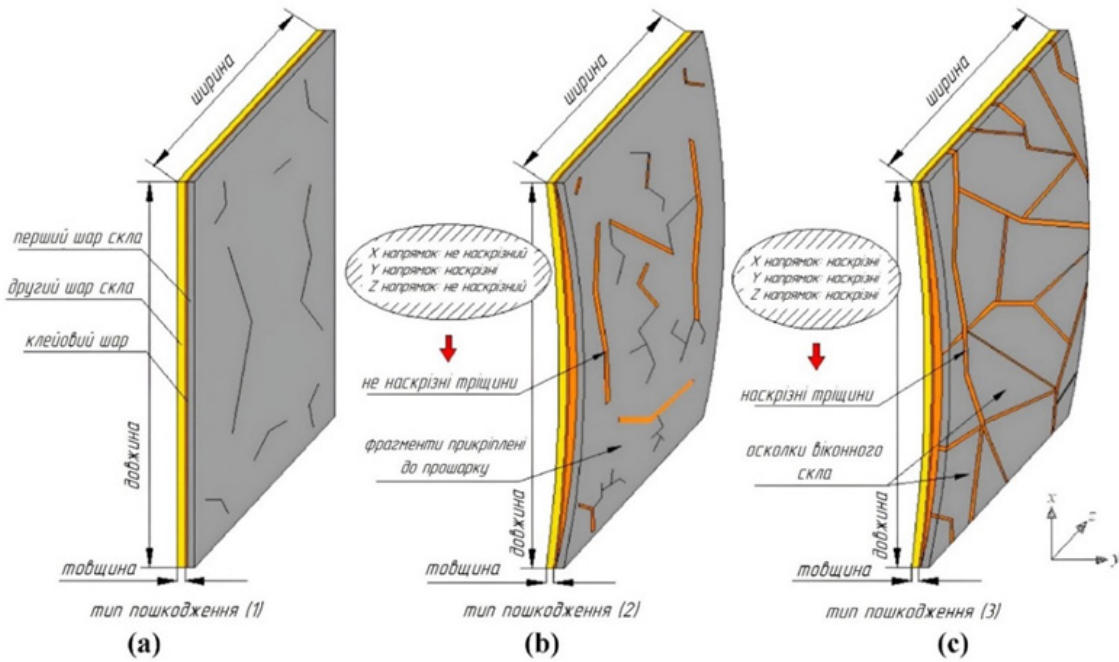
Режим руйнування багатошарового загартованого скла [52]:
